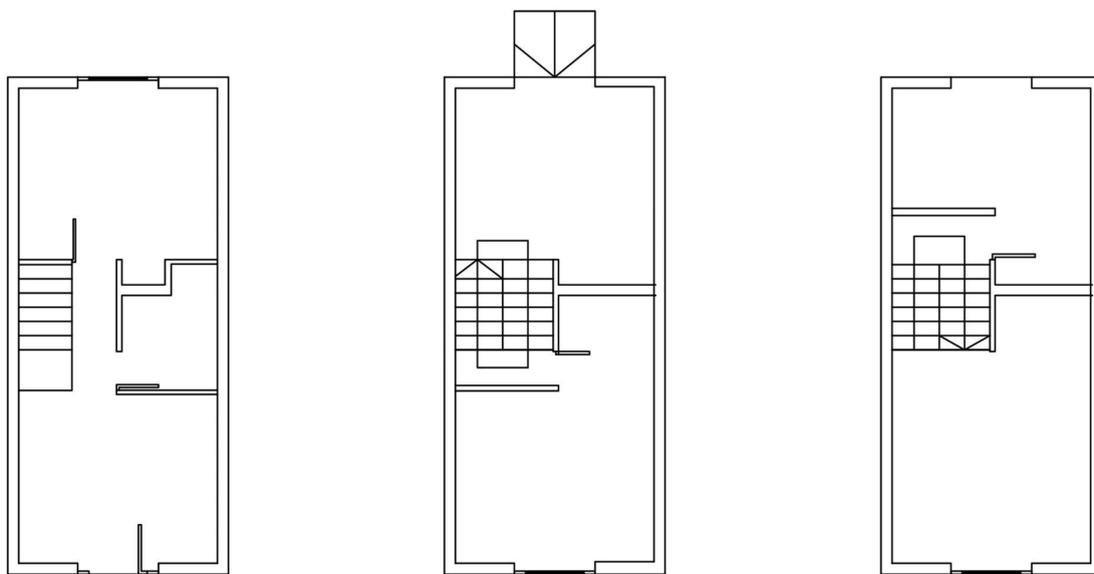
Planimetría nivel 1, 2 y 3 de la vivienda, Elaboración propia
